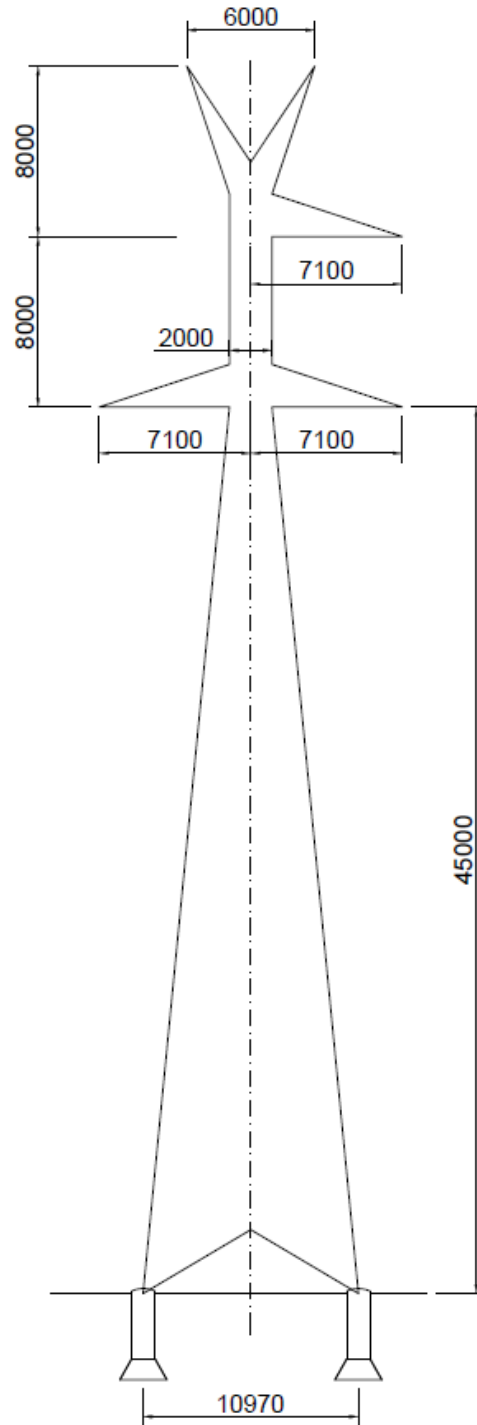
Apoyo TORNADO 150 A2Ha 45 (apoyo nº 2 y 3)
